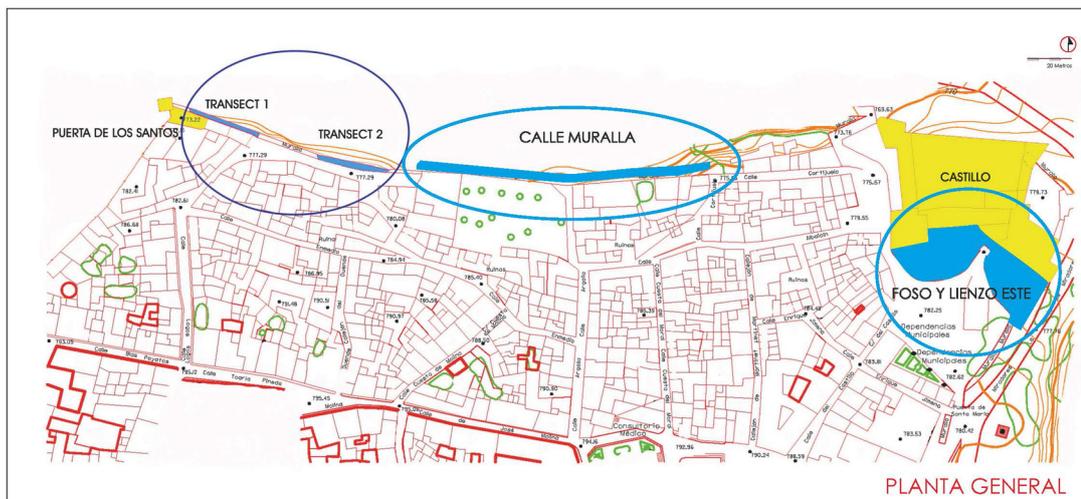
Plano general de actuación: Calle Muralla, Exterior de la Muralla Norte y Foso del Castillo.
